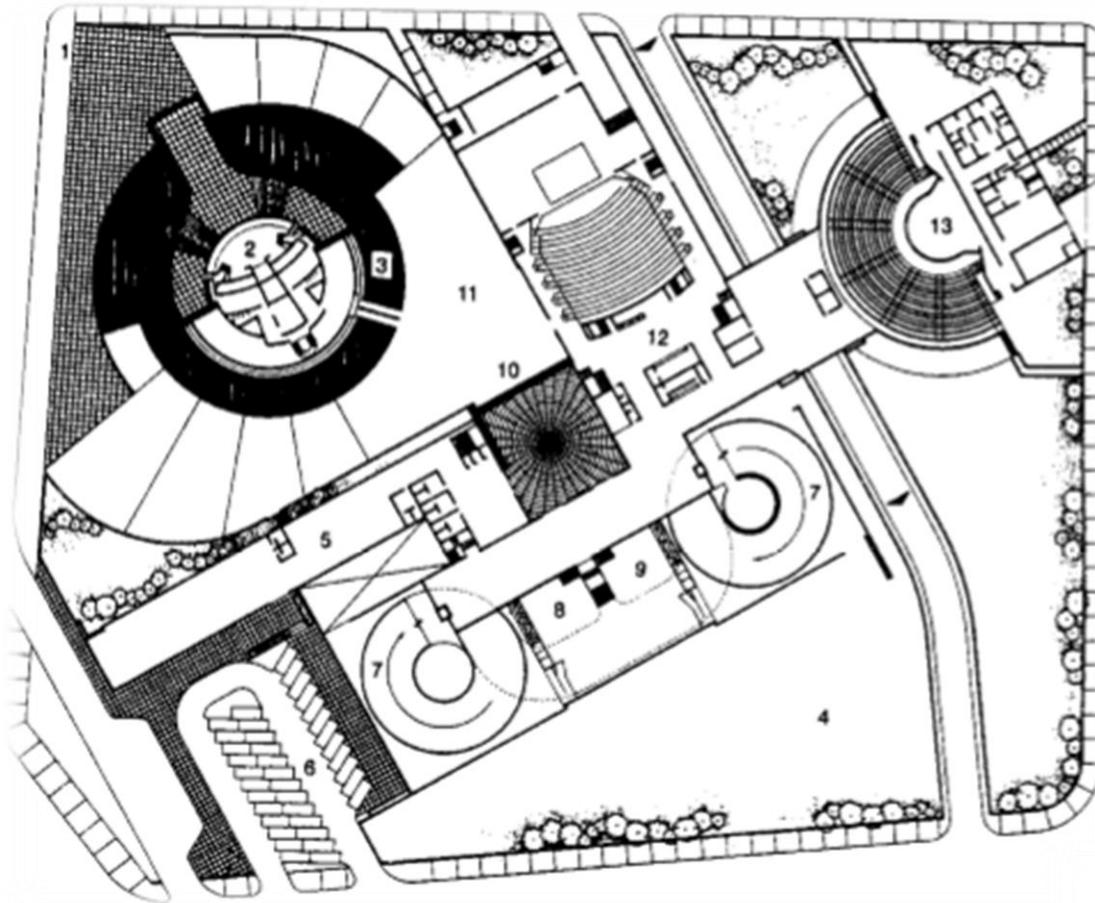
Planta del Centro Cultural de Tijuana.
